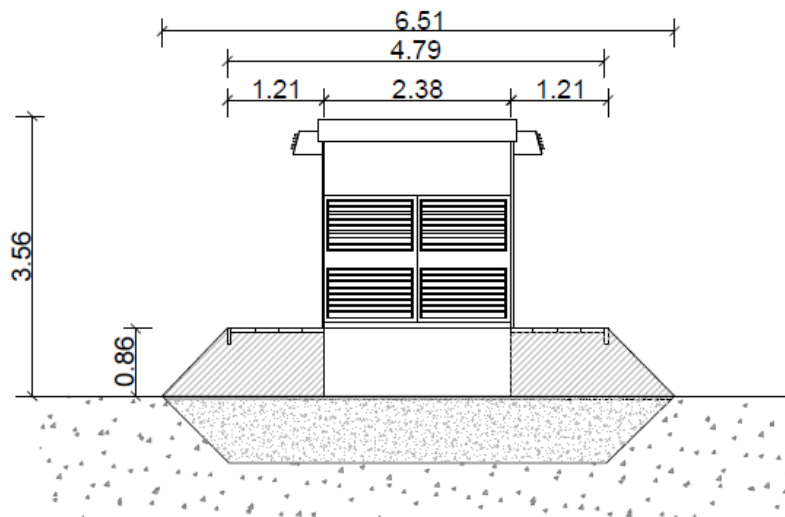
Pianta e prospetto anteriore della cabina inverter e di trasformazione
